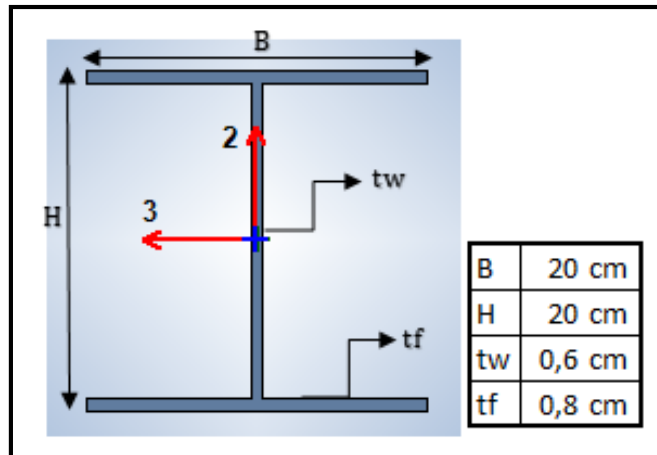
Dimensiones, Columna 2 con pórticos arriostrados.
